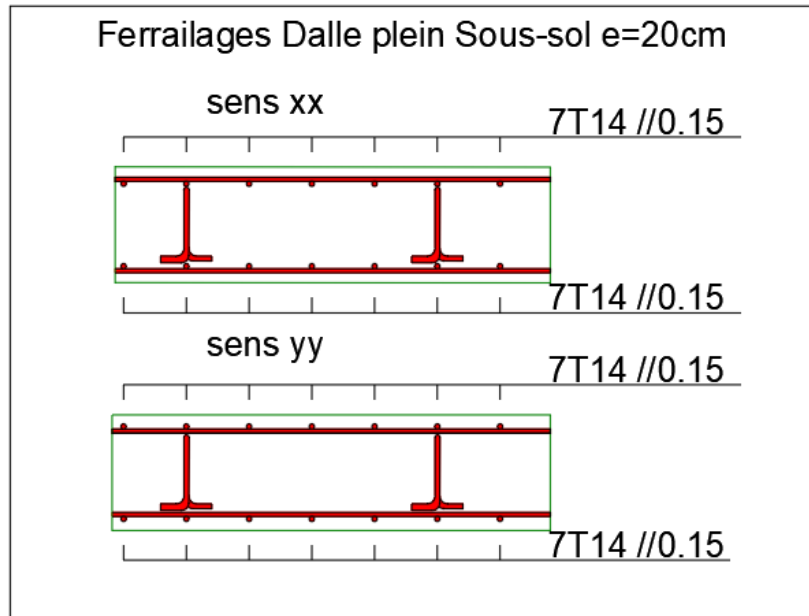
Schéma de ferrailage pour la dalle sou-soul.
